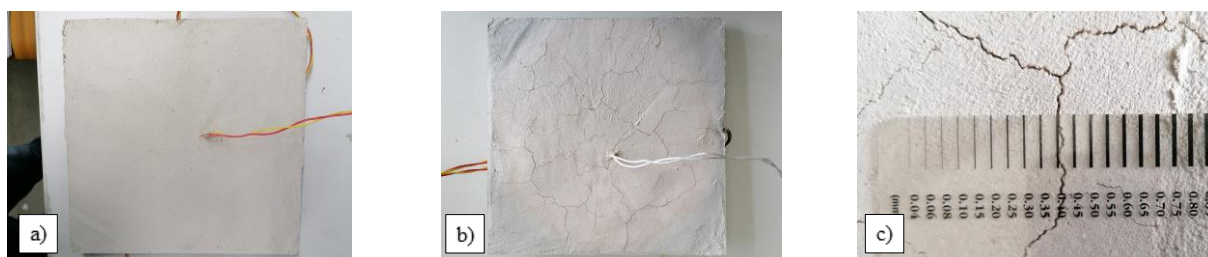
Provete P_A4_3_MI: a) Provete antes do ensaio; b) Provete após o ensaio; c) Fissuração do provete após o ensaio.
